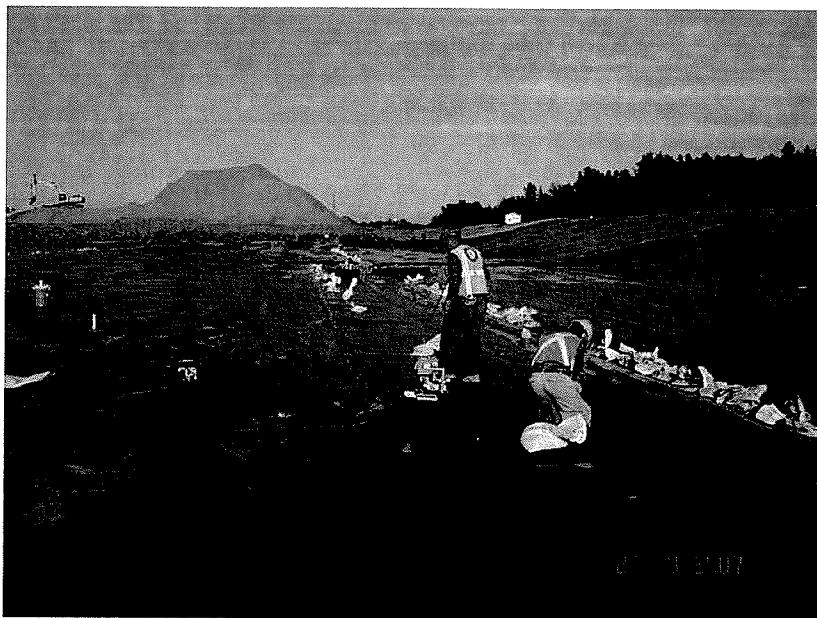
Préparation des surfaces pour soudures double fusion sur géomembranes
